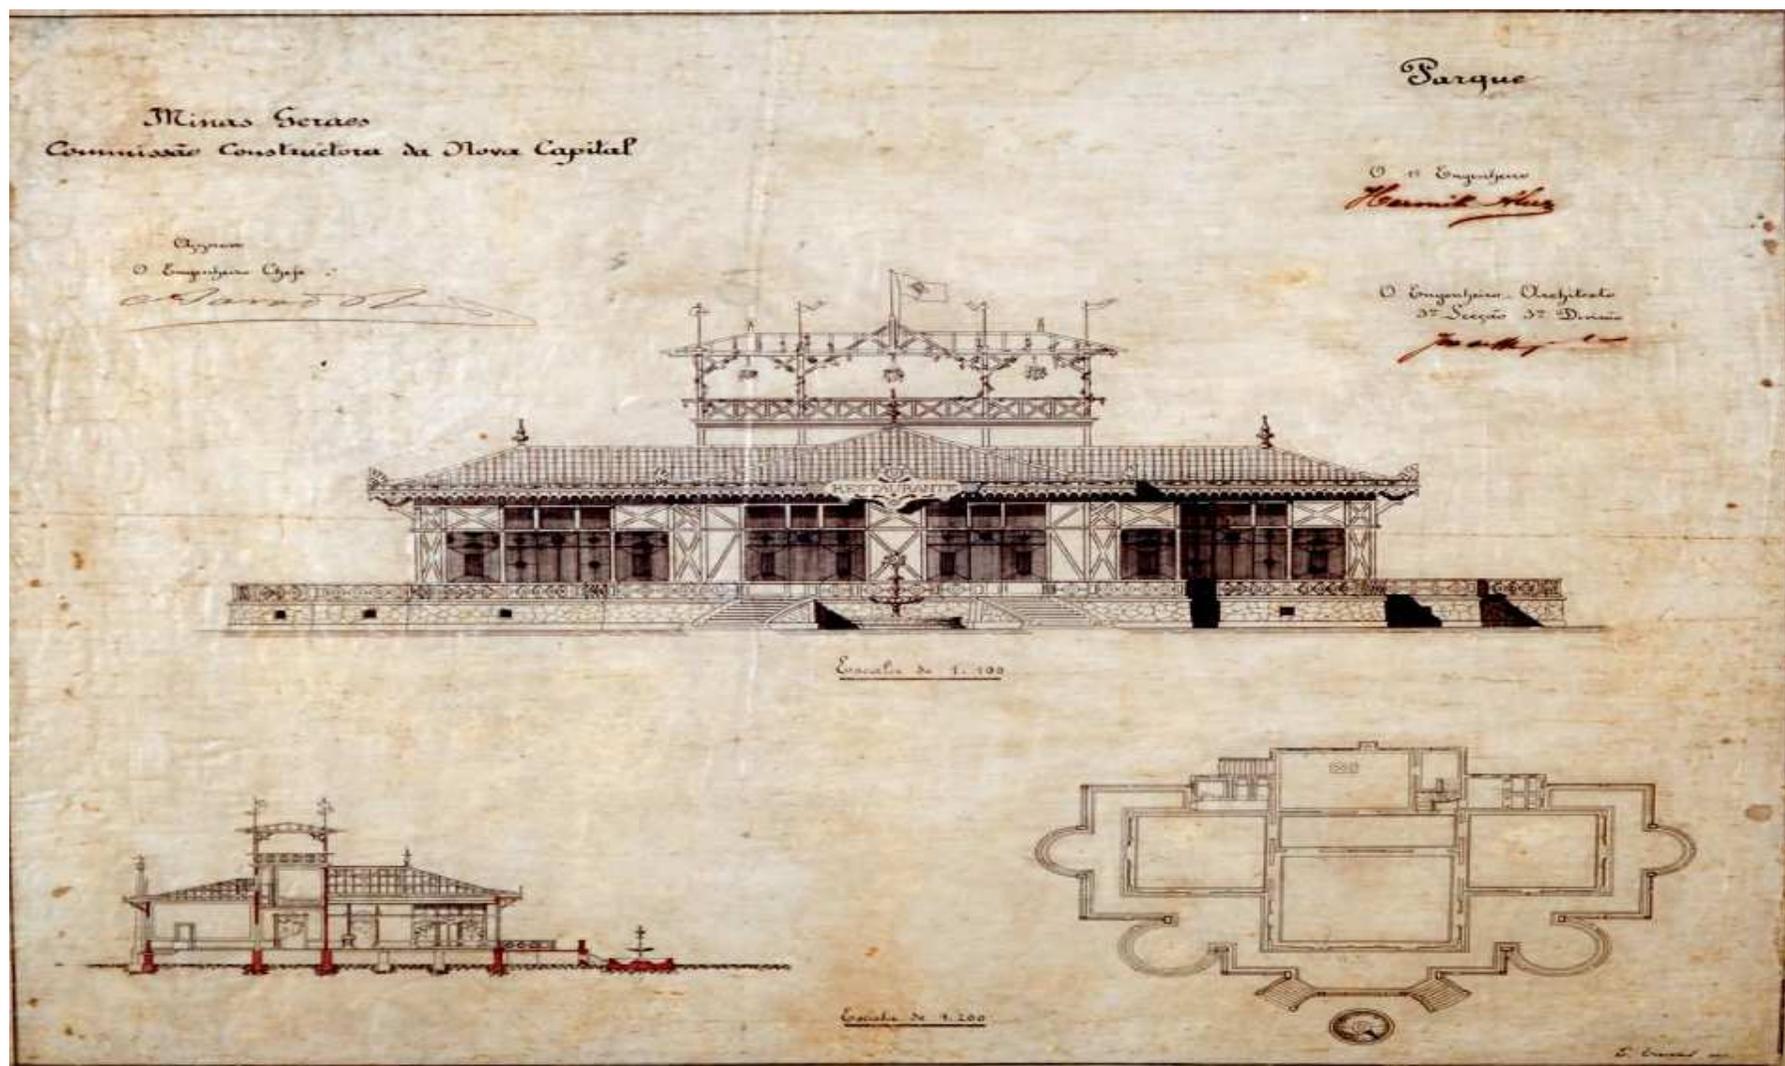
Parque-Restaurante, Projeto Arquitetônico (sd).
